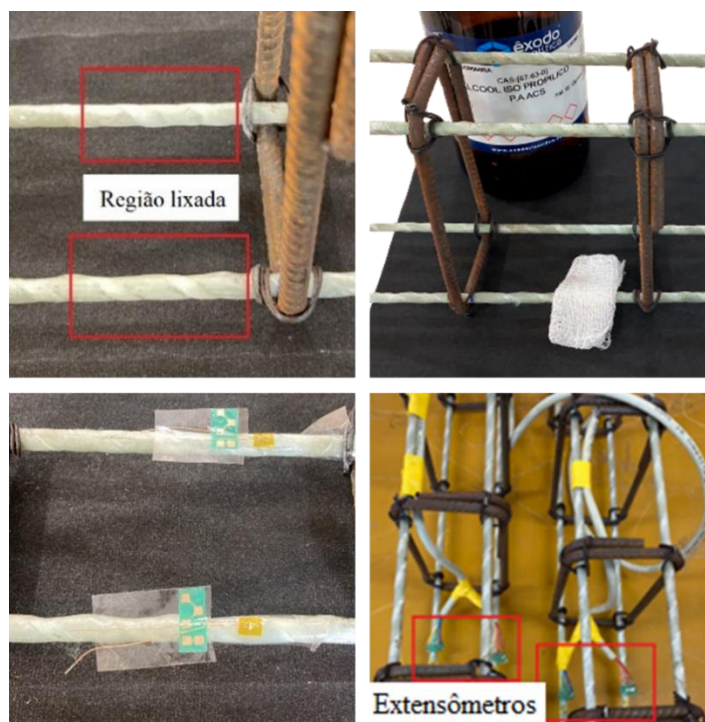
Procedimento de instrumentação das armaduras longitudinais das vigas
